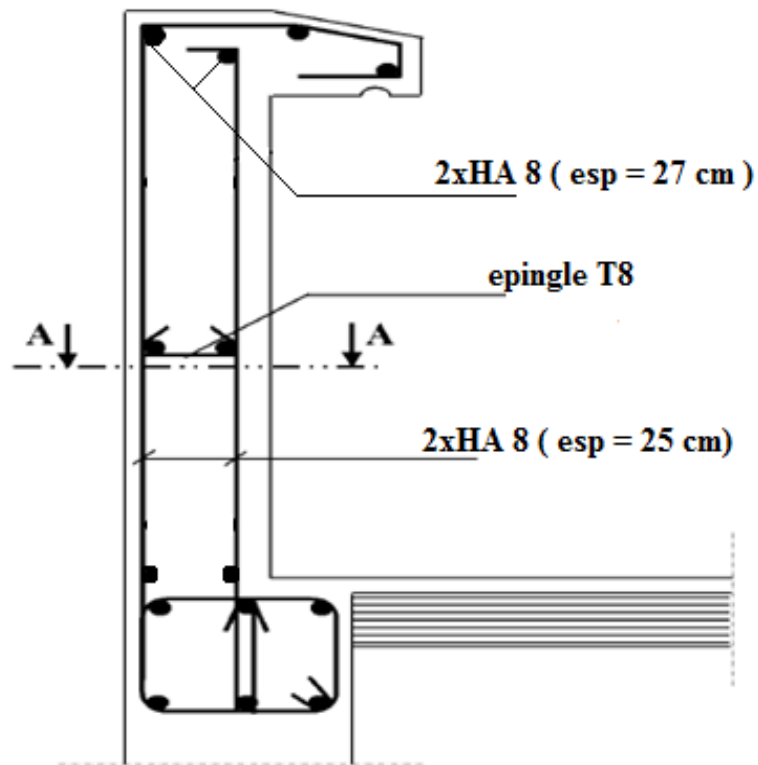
Plan de ferrailage de l'acrotère COUPE A-A
